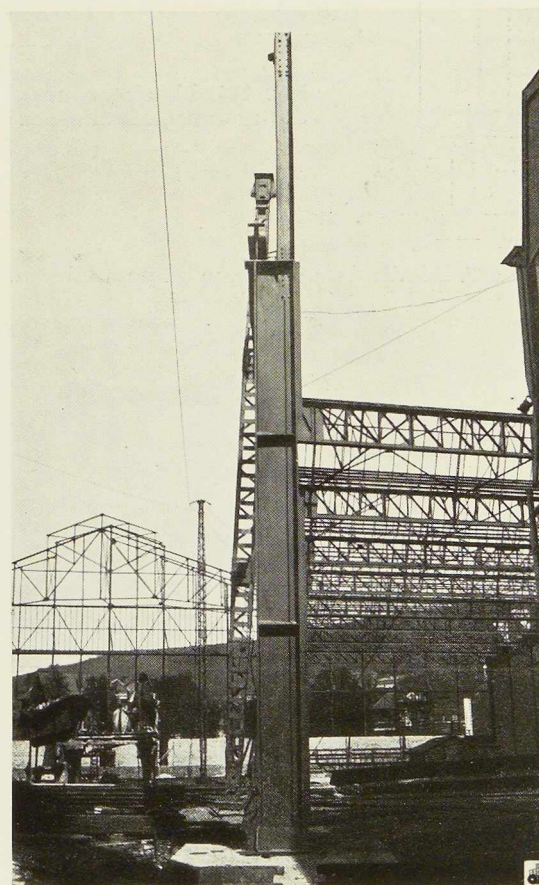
Colonne en poutrelles H supportant la charpente du hall de 31 mètres.
